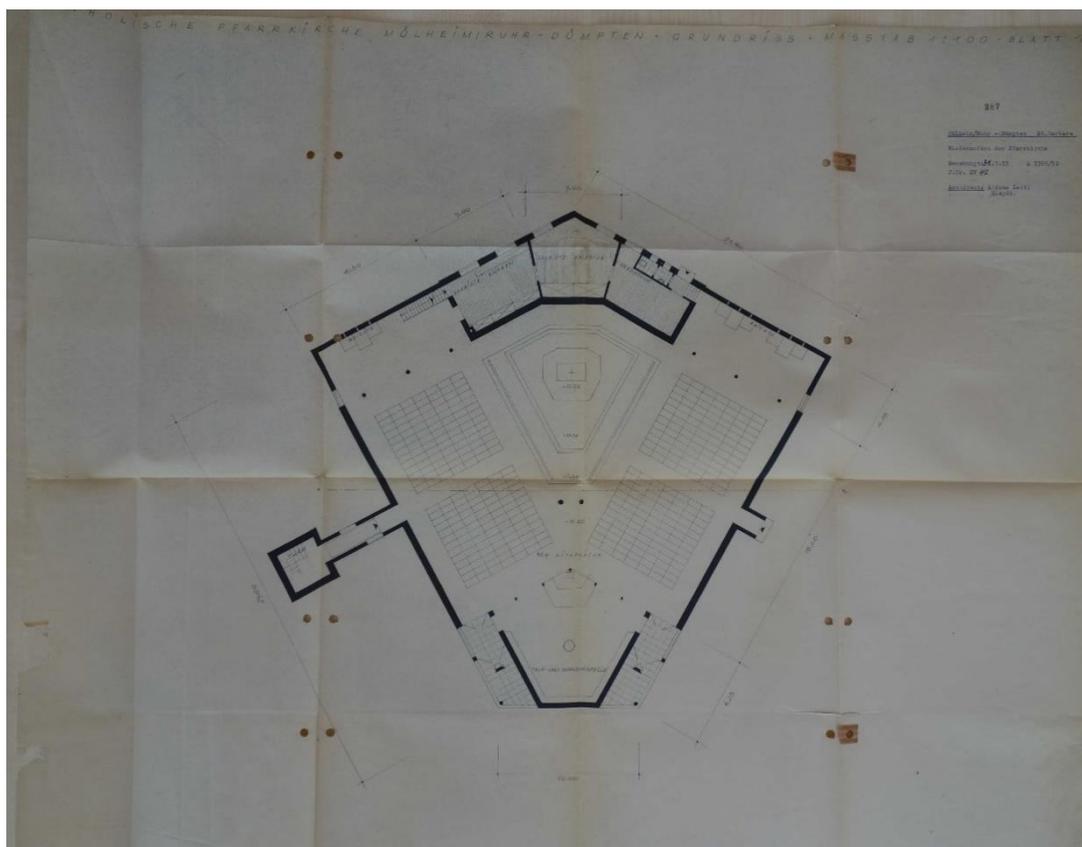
Grundriss, Archiv Bistum Essen.
